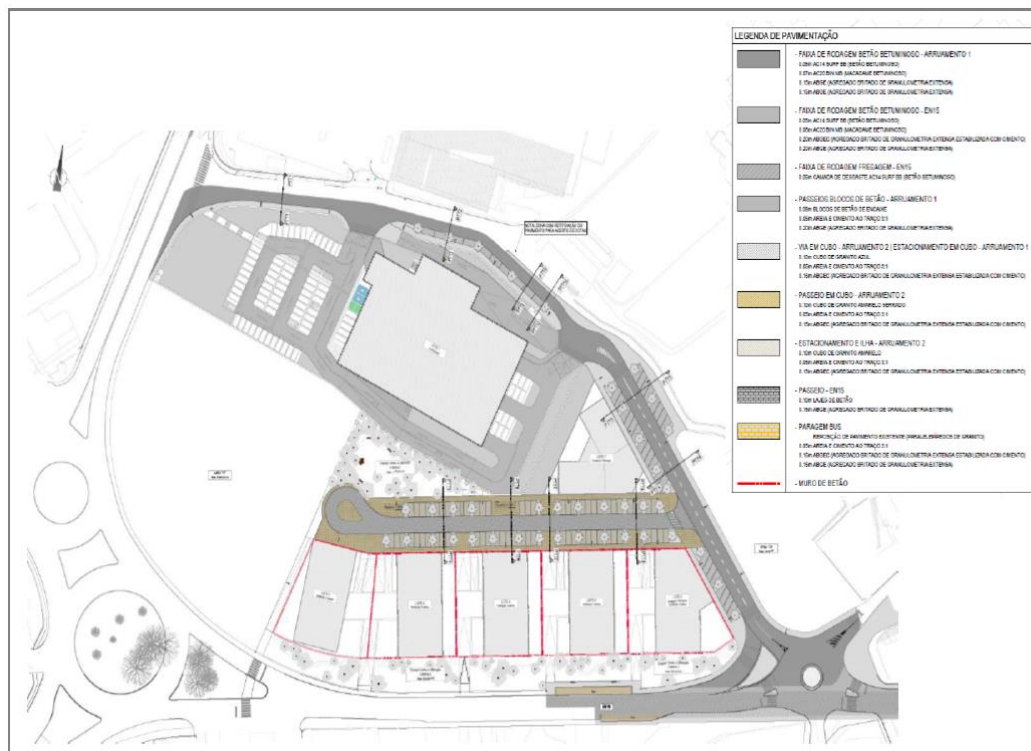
Extrato da Planta de Pavimentos (Fonte: EIA - Relatório Síntese, junho 2023)
